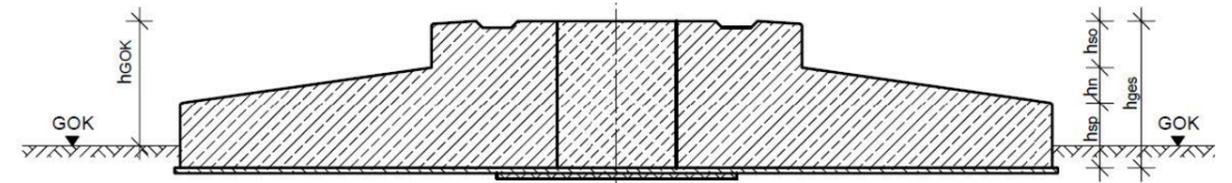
Coupe de principe d'une fondation surélevée (source : Enercon, 2020)
